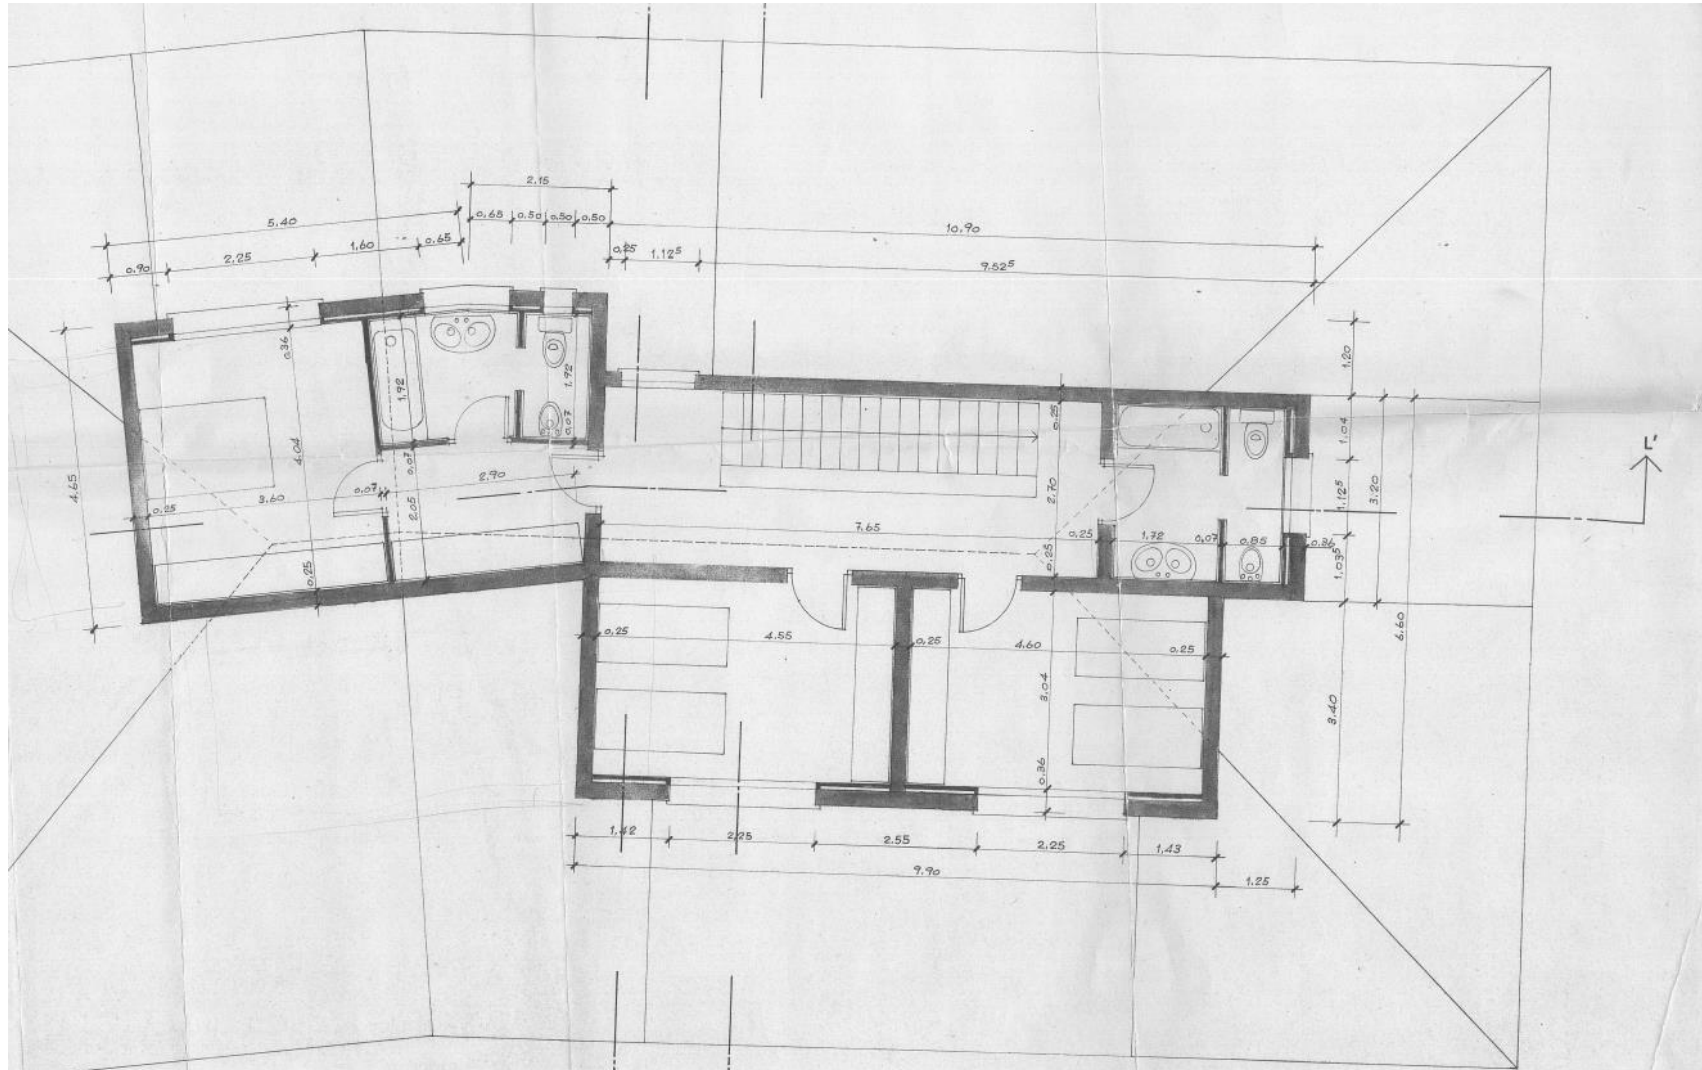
Imagen del plano original de la Segunda Planta (Fuente: Planos originales realizados por D. Antonio Miranda Sánchez)
